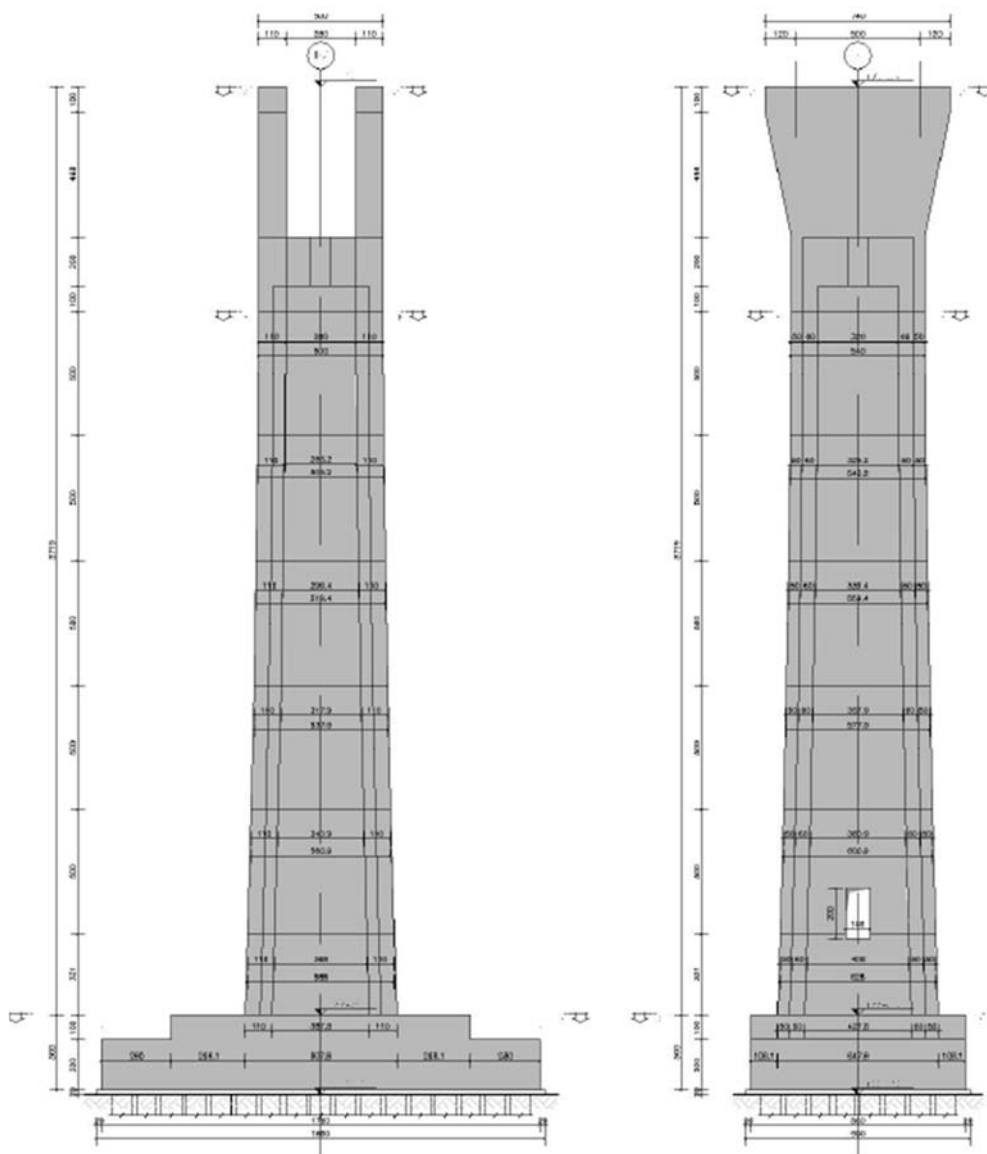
Prospetto pile IP2, IP3, IP4, IP5
